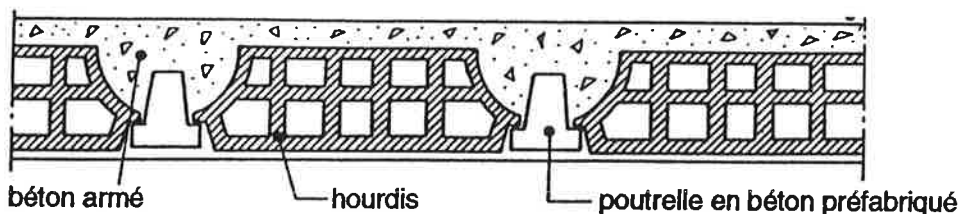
Type courant de toiture plate en Algérie. On place les hourdis entre les poutrelles préfabriquées et on coule par-dessus une dalle de béton armé.
